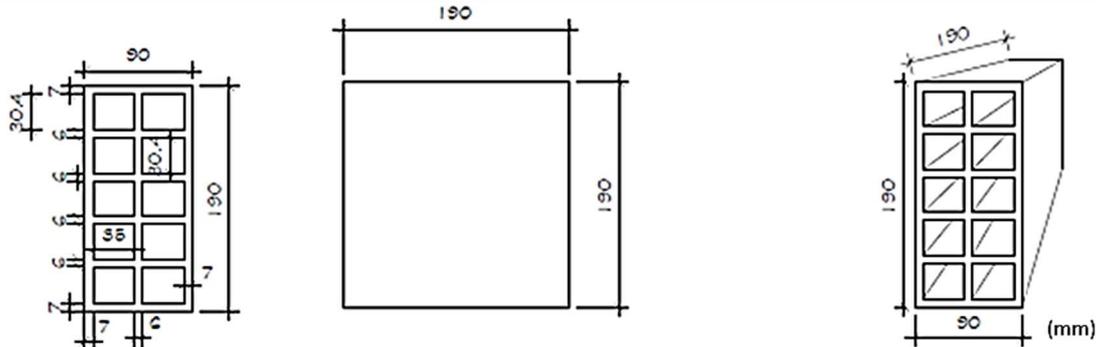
Detalhamento do ½ bloco cerâmico de vedação com furos na horizontal(90mmx190mmX190mm).
